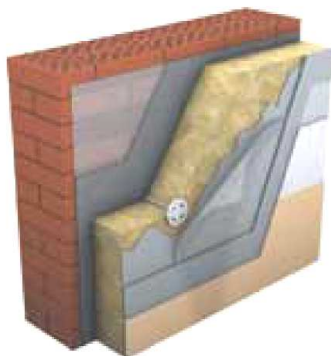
Система утепления фасада с тонким штукатурным слоем [3]
